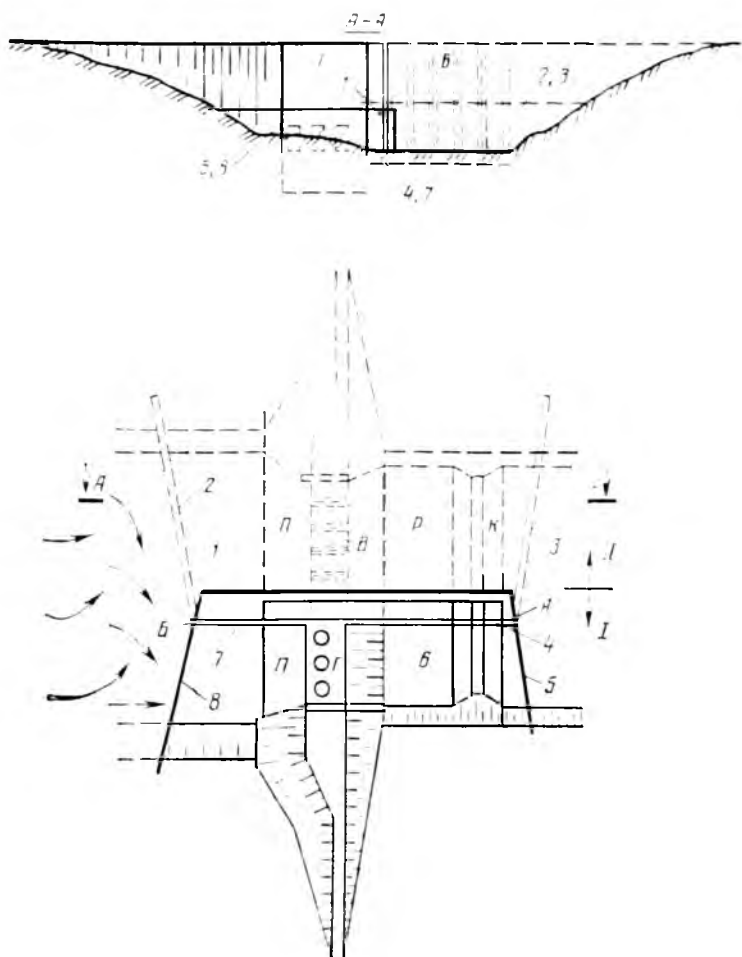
Схема возведения гидроузла методом секционных перемычек:
